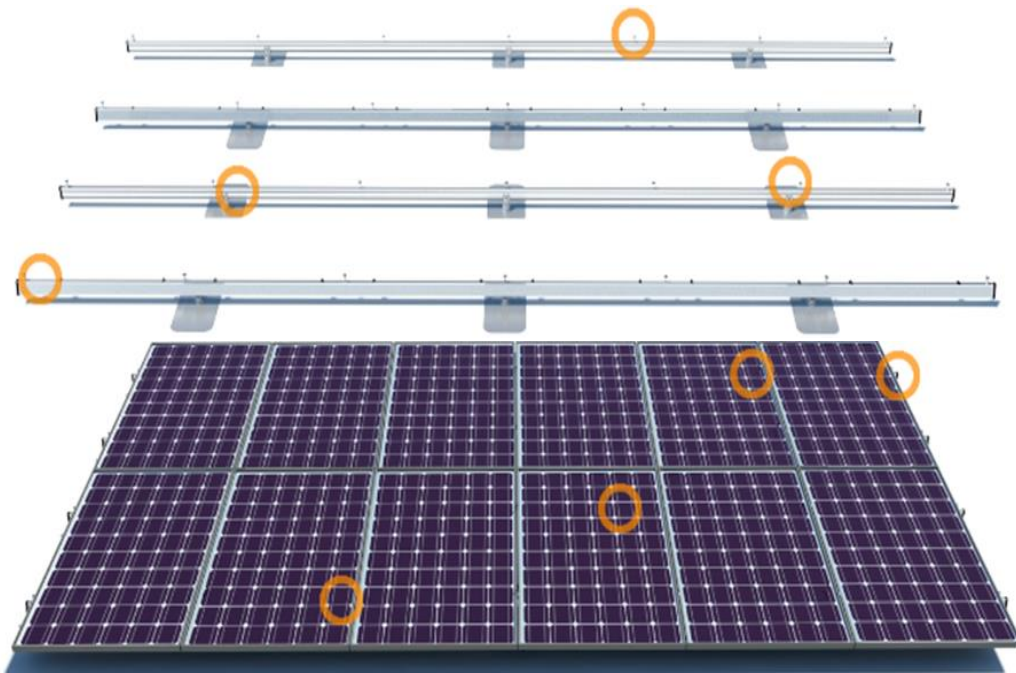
Estructuras de soporte para módulos fotovoltaicos IRONRIDGE.
